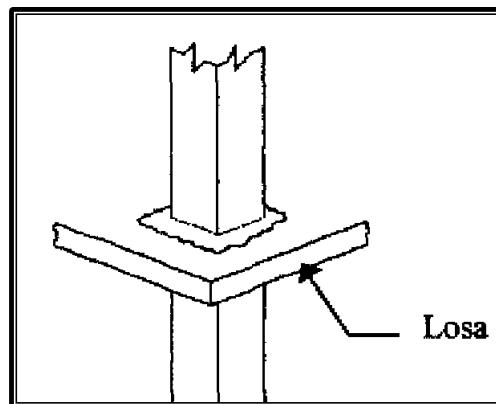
Grietas alrededor de la columna siguiendo la geometría de la misma (falla por punzonamiento en losas sin viga)
